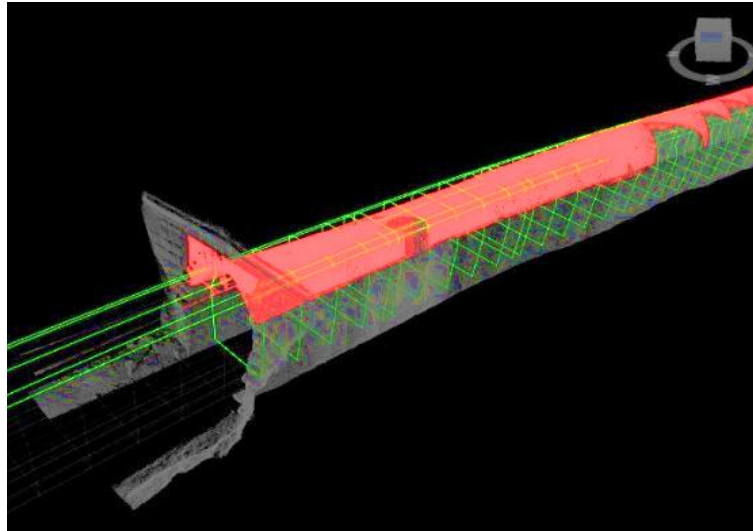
Detalle de la afección en la bóveda de uno de los túneles. Fuente: Elaboración propia (2018).
